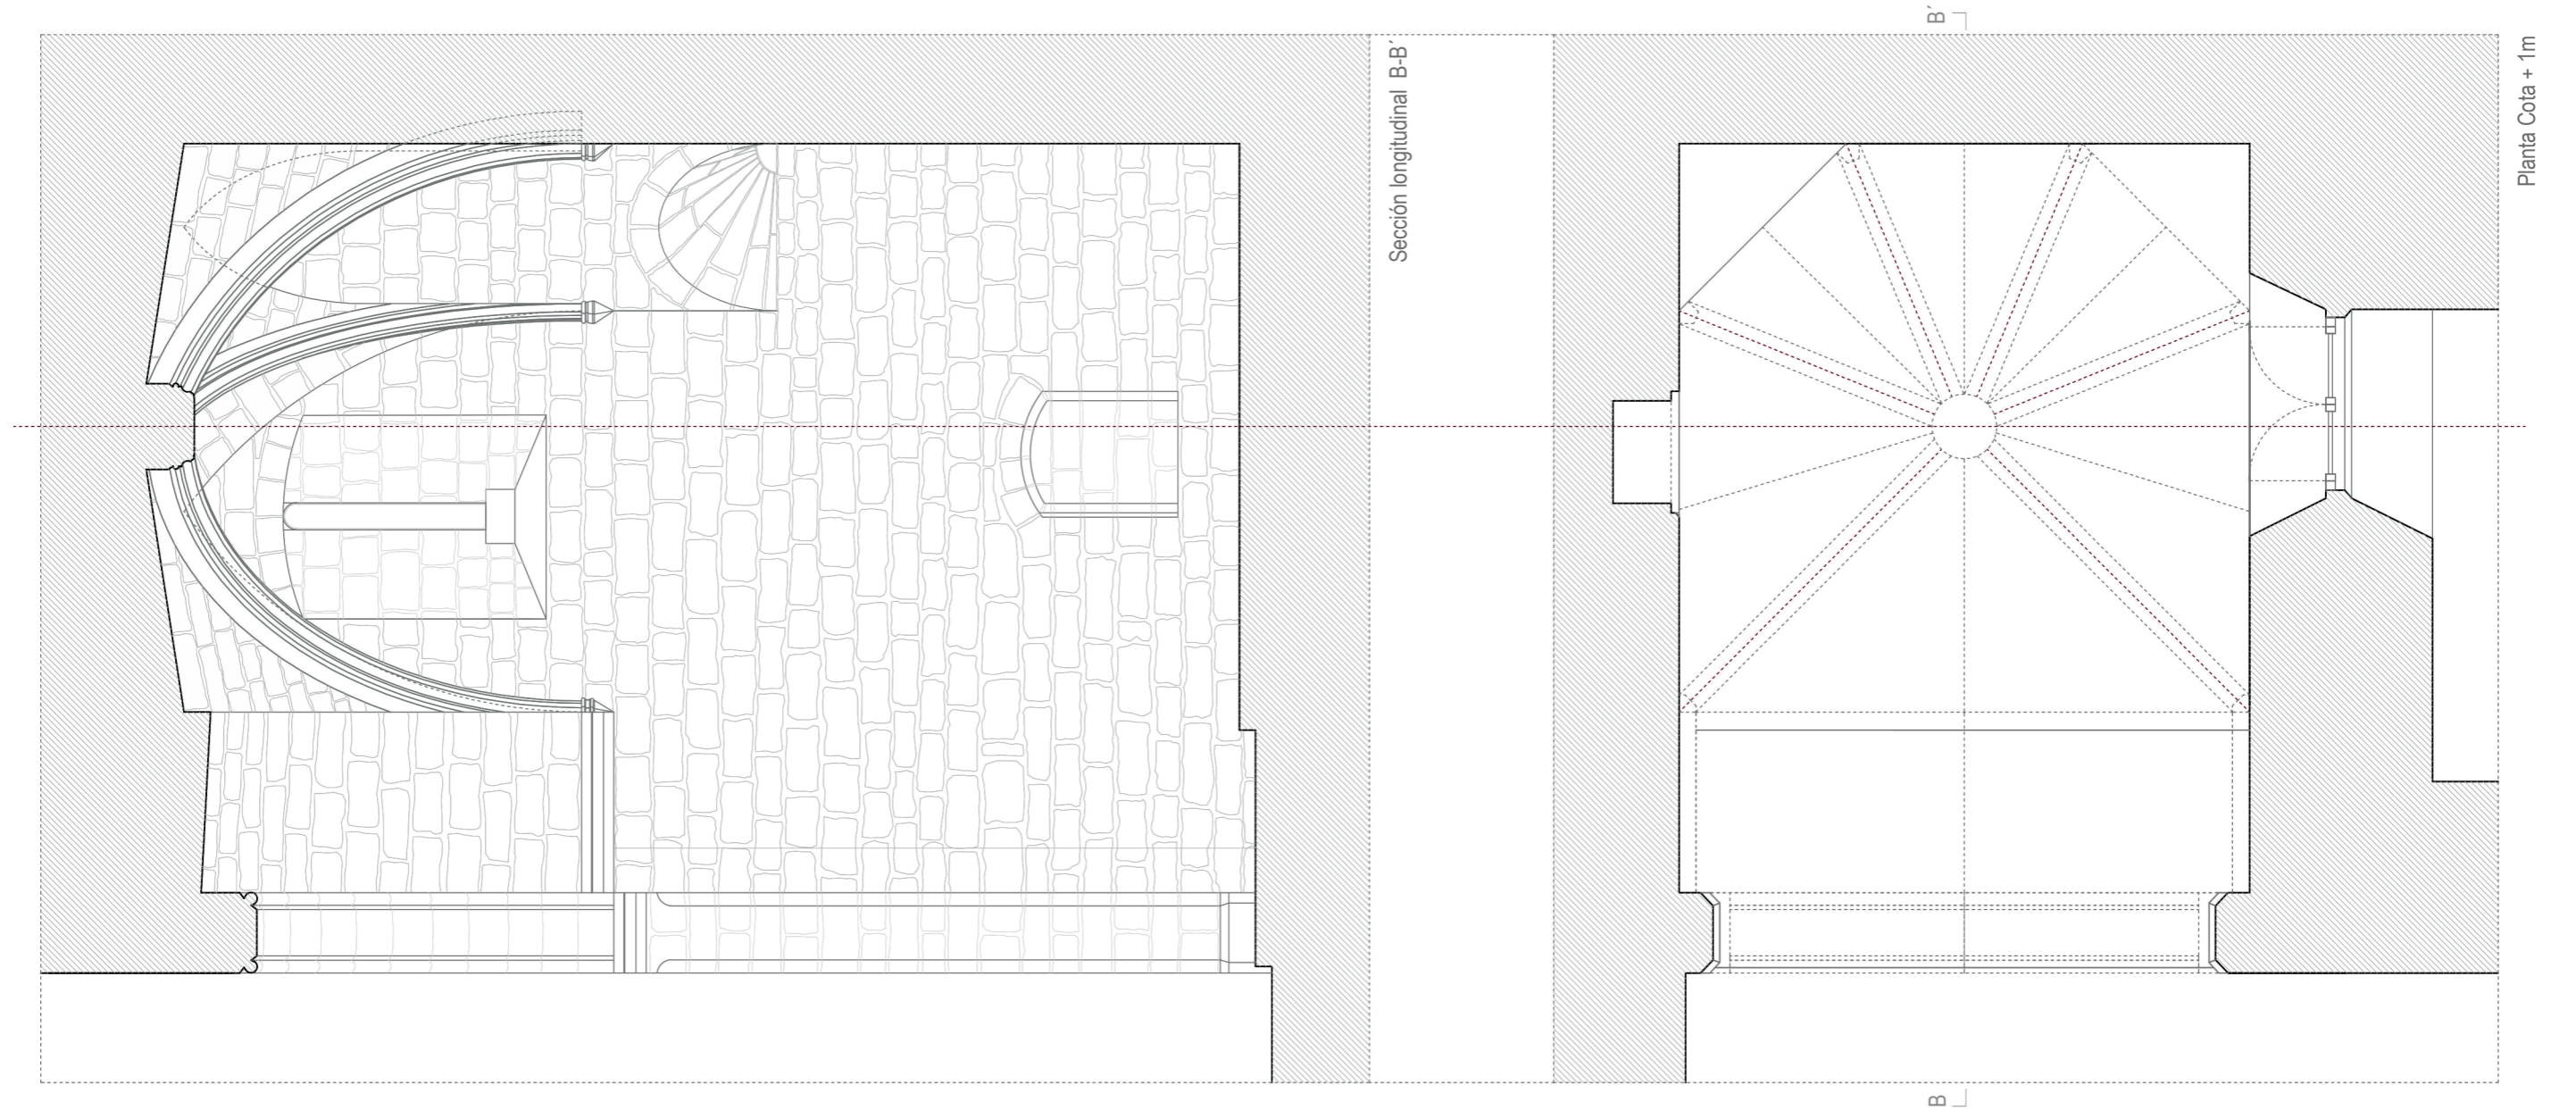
Planta y sección de la capilla a escala 1:50 (Dibujo propio)
